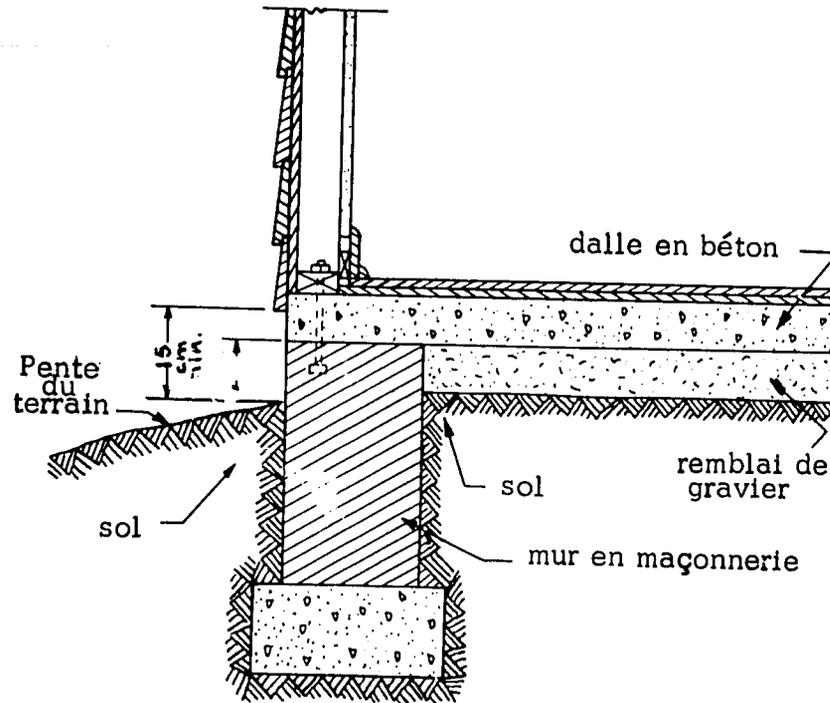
Construction sur dalle monolithique en béton posée à même sur le remblai.
